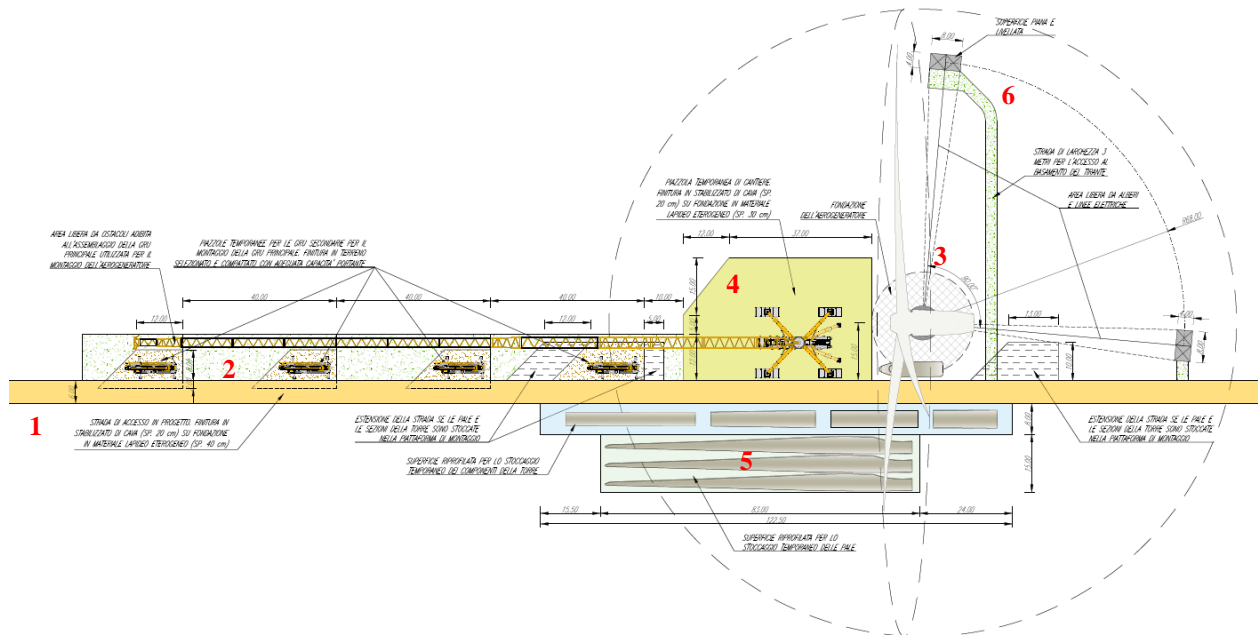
Piazzola di montaggio; 1. Strada di accesso; 2. Blocchi ausiliari; 3. Area di assemblaggio della torre; 4. Area di lavoro gru principale; 5. Area di stoccaggio; 6. Blocchi di ancoraggio - controvento.
